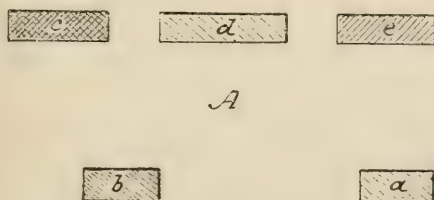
Plan de bâtiments disposés sur deux lignes parallèles.
